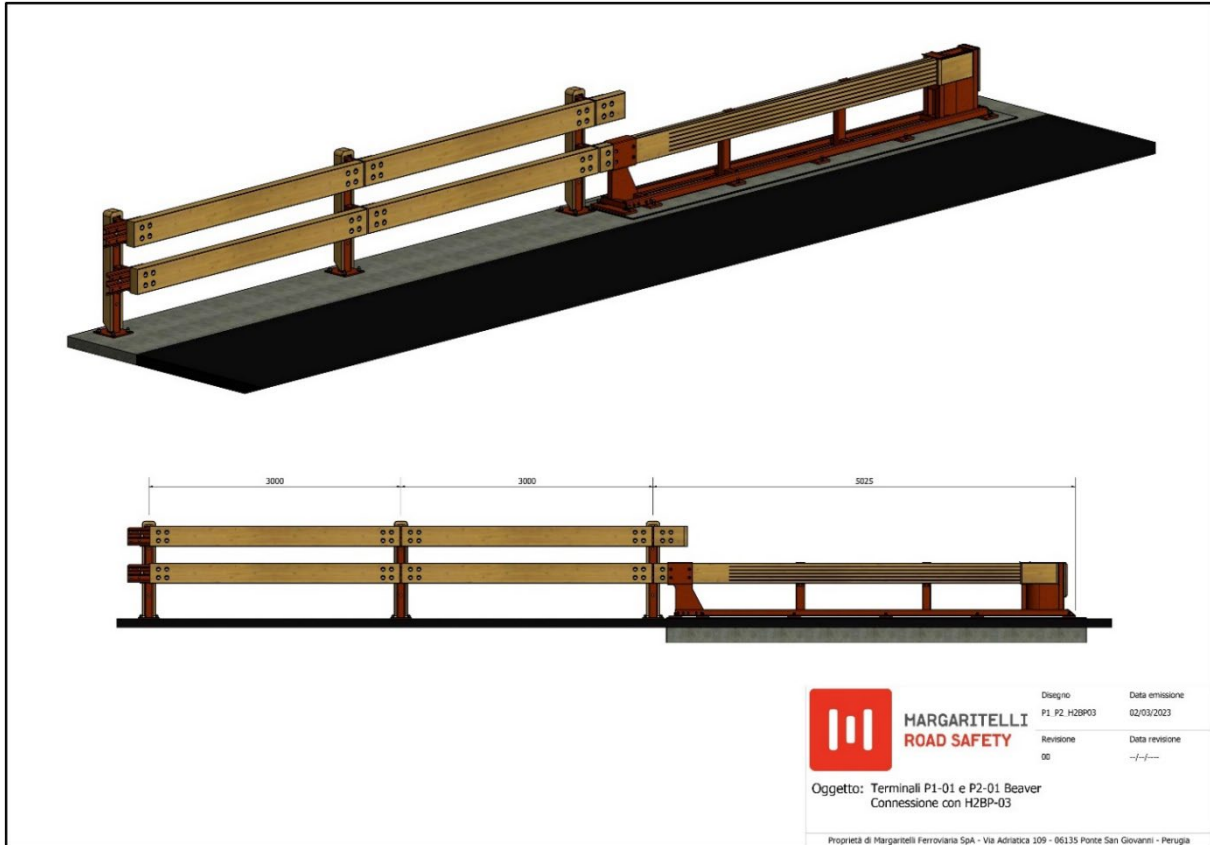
schema della barriera con collegamento diretto con terminale P1-01 o P2-01 Beaver
